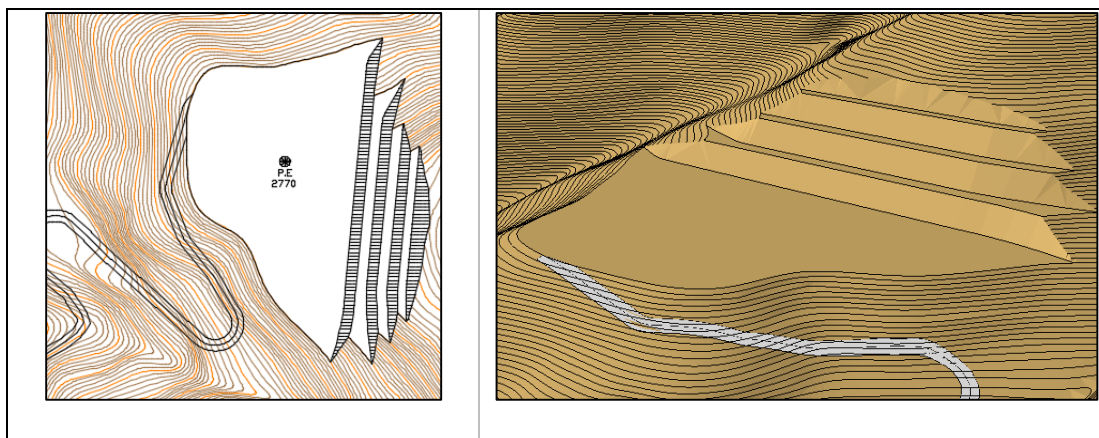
Vista en planta y en 3D de la Fase 4 de explotación.
